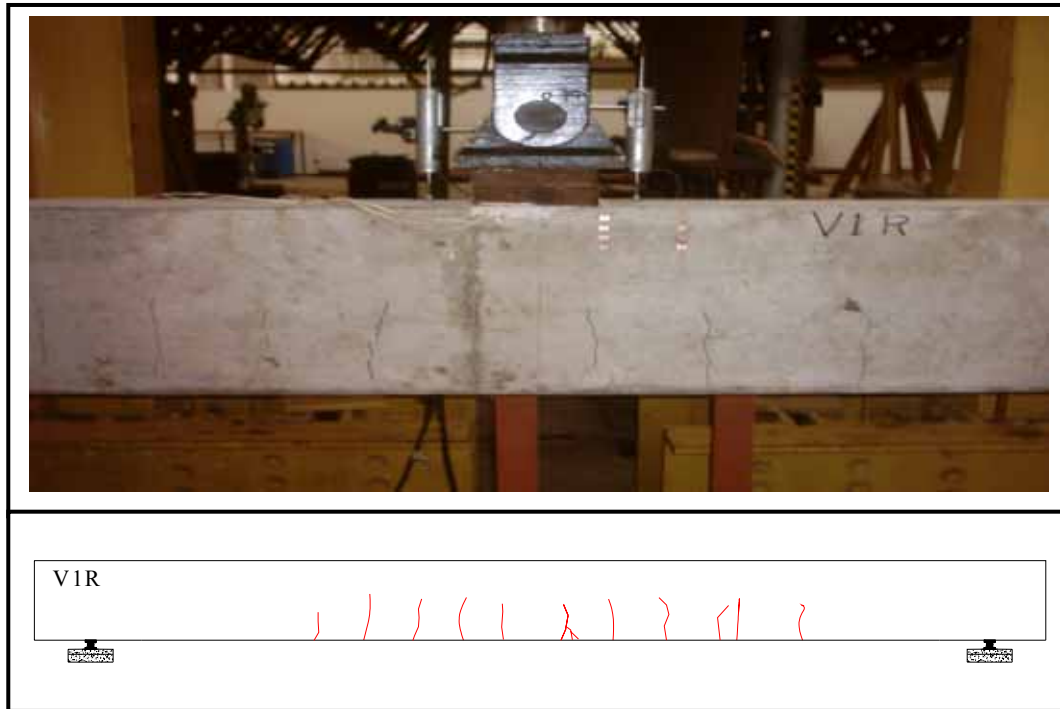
Fissuração da viga V1R sob a carga máxima aplicada no ensaio de pré-fissuração.
